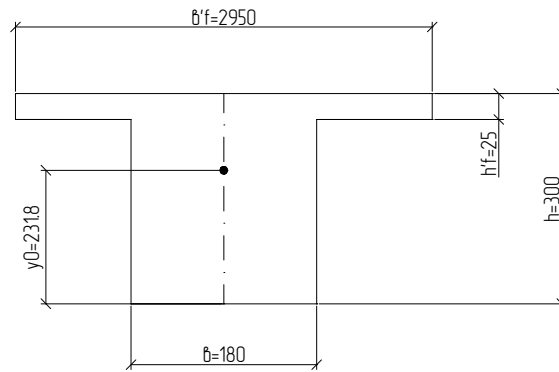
Еквівалентний поперечний переріз плити
